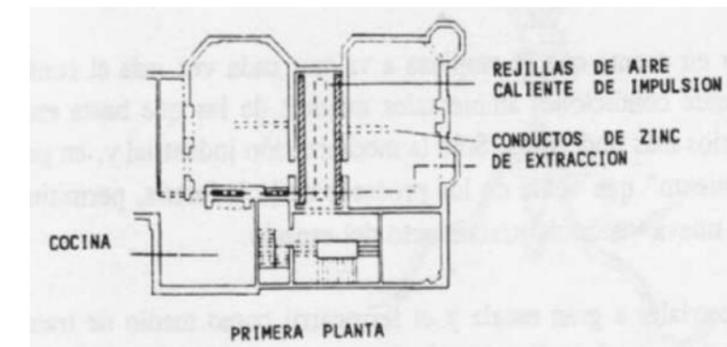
Planta del primer del Proyecto "Casa Octágono" Tomado de (Banham, 1975).
